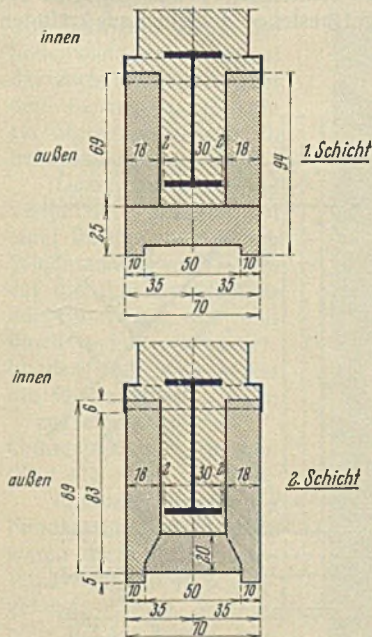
Werksteinverkleidung und Ausmauerung einer Zwischenstütze der Ehrenhalle.
